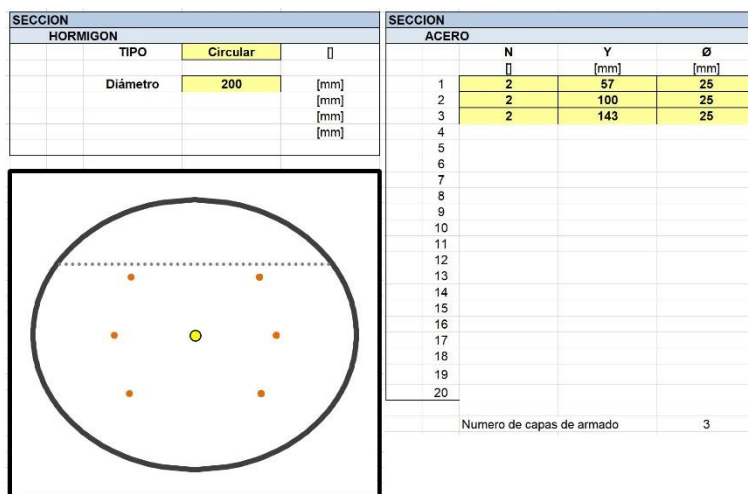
Sección y armado del tirante posterior. (Fuente: Elaboración propia)
